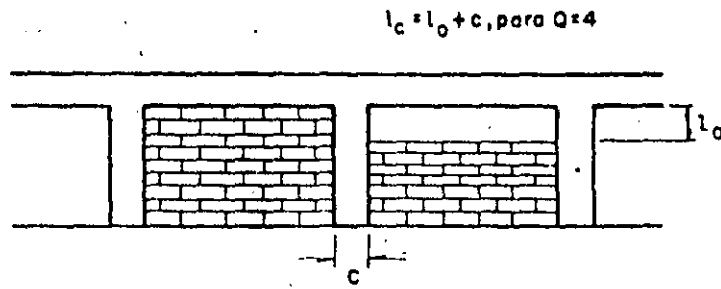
Longitud requerida de confinamiento para columnas en contacto con muros de mampostería
